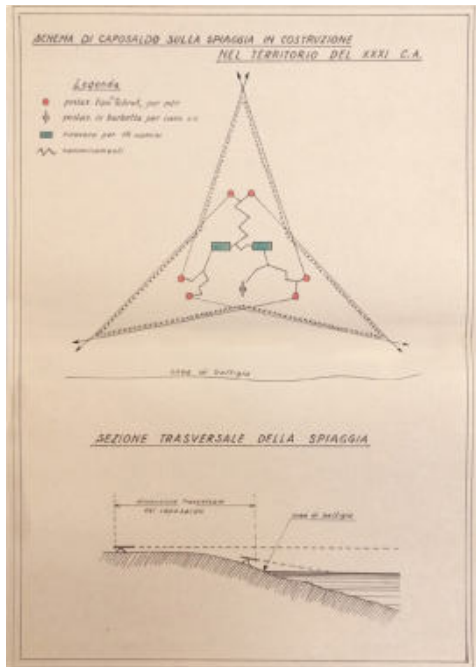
Schema di caposaldo “avanzato” sulla spiaggia, 1943 (AUSSME, Fondo L-12, b. 34)
